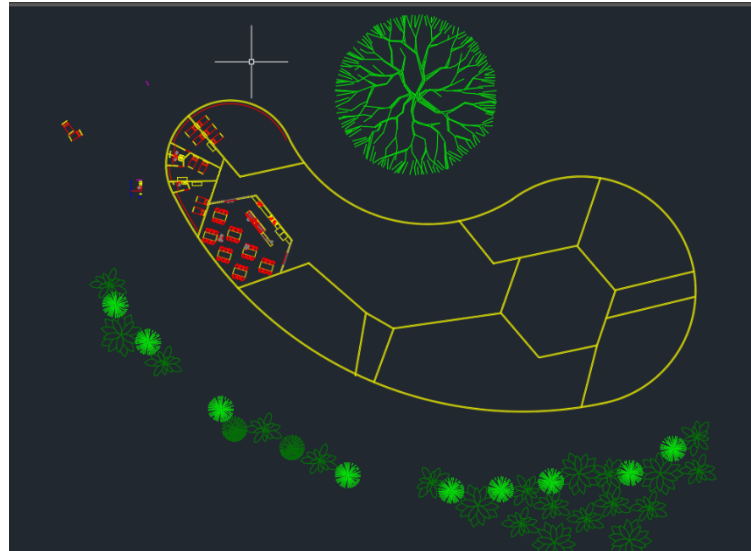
Planta Baixa do projeto do novo Fab Lab em Bragança
